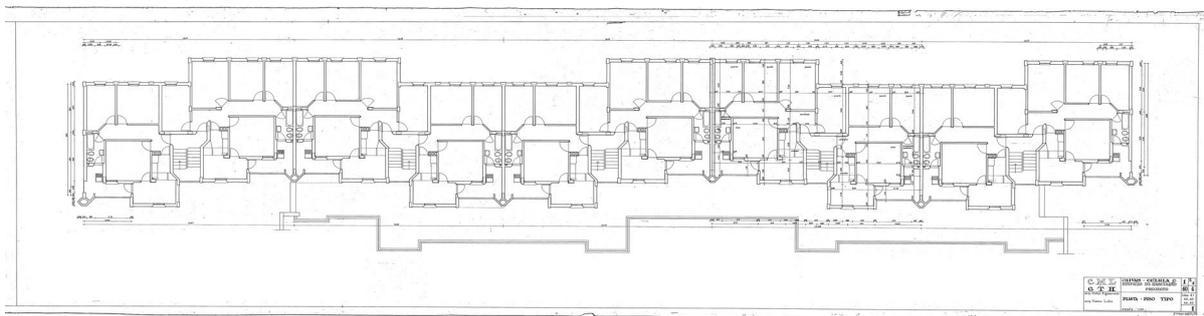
Projeto: lotes 41 a 45, planta do piso tipo
